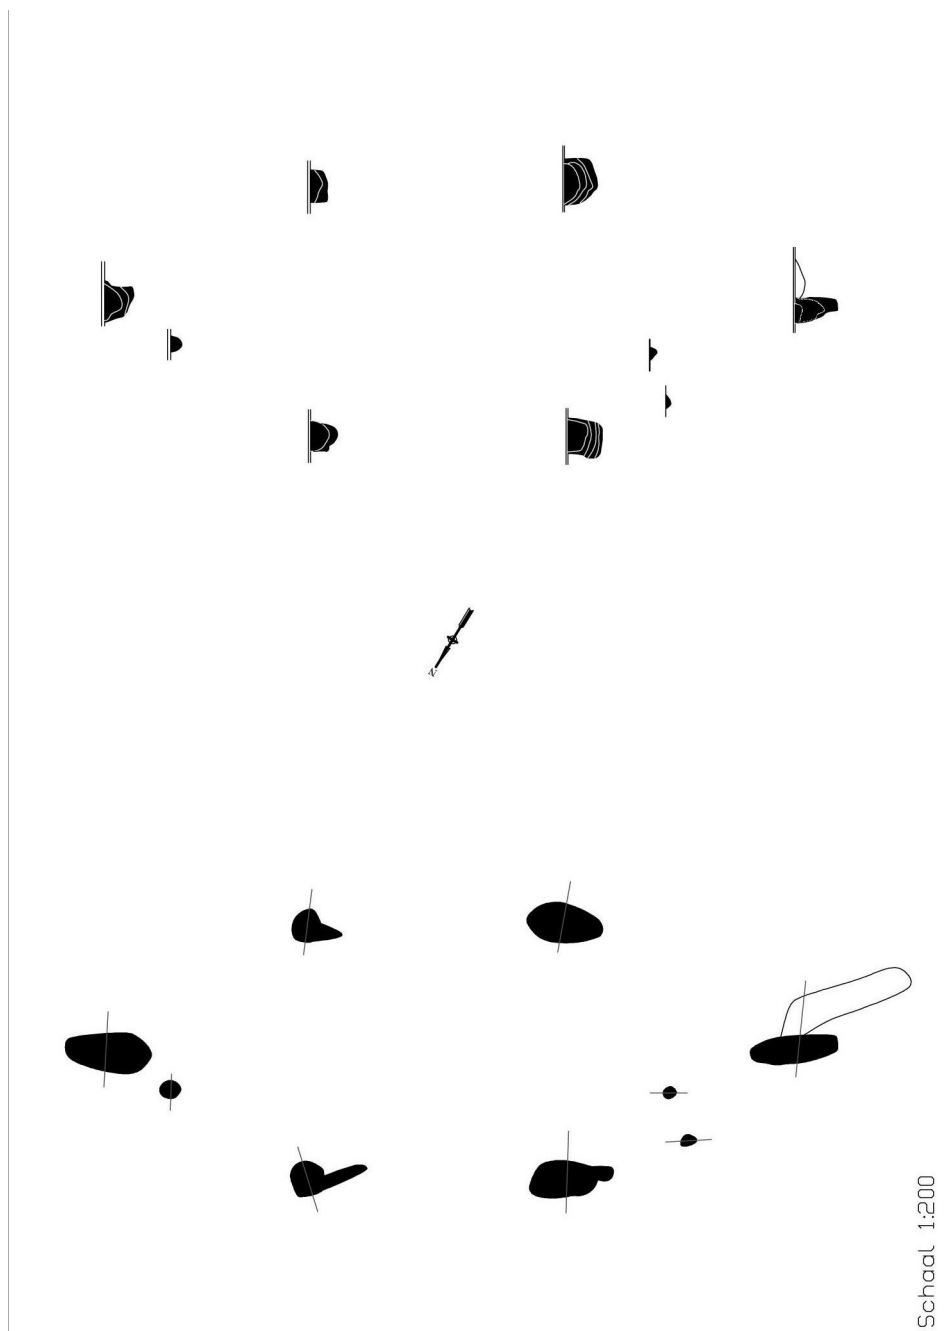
Plan en coupes van de eerste gebouwplattegrond
